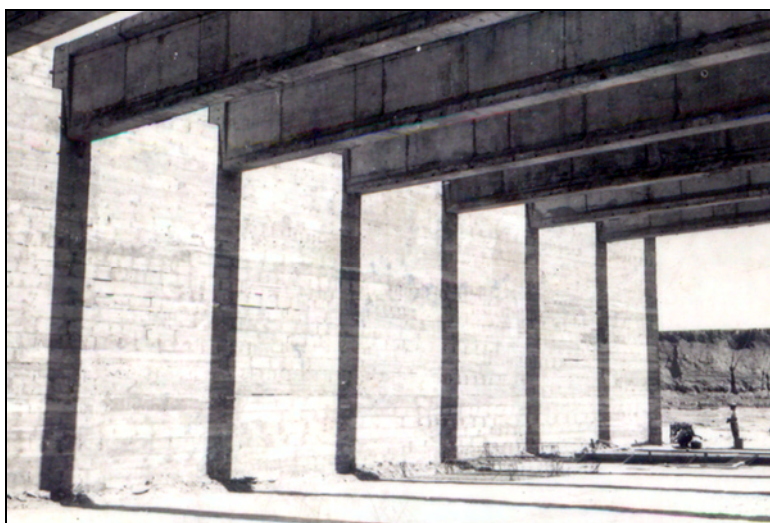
Um dos quatro muros de encontro apoiando as vigas longitudinais em 1959 (Arquivo Público DF, autor Mário Fontana).
